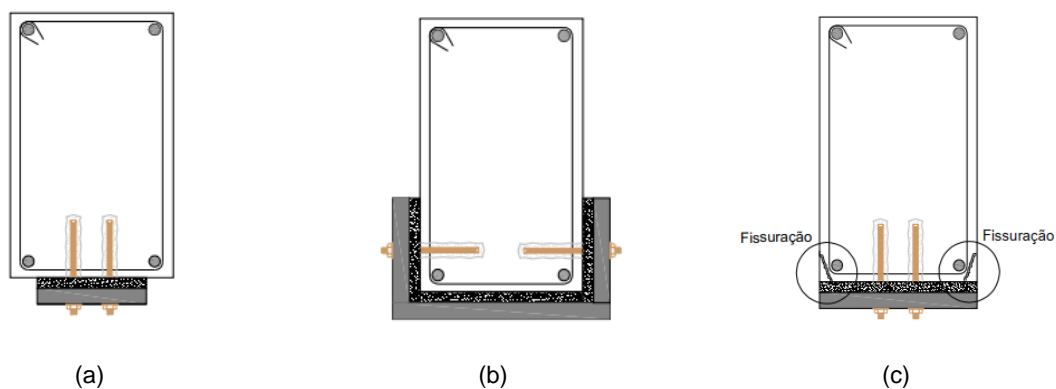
Solução mais recorrente da disposição de armaduras (a): execução quando a área de armadura de reforço é elevada (b) e solução a evitar devido à fendilhação nos cantos (c) – adaptado de Sousa (2008)
